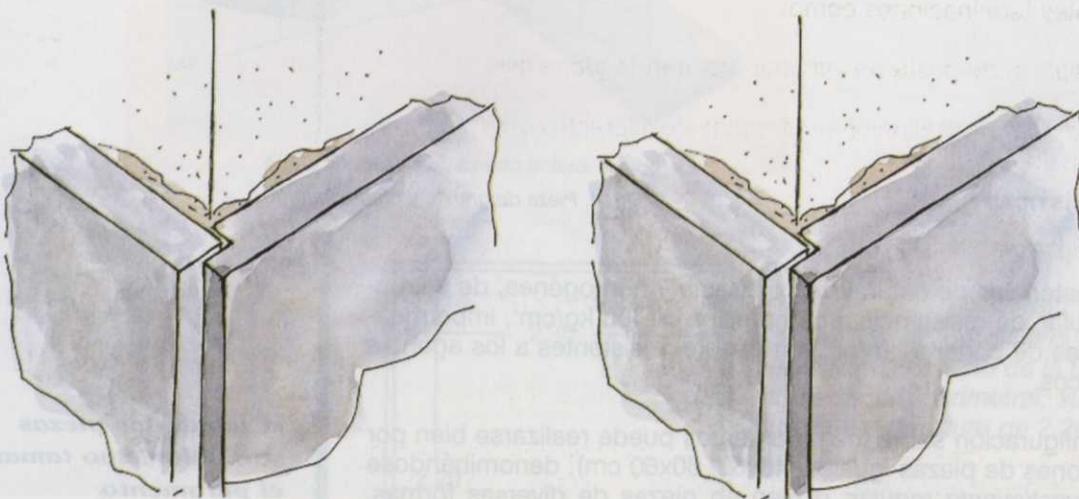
Unión en canto pilastra y a canto visto y junta de unión a tope trascortado.
